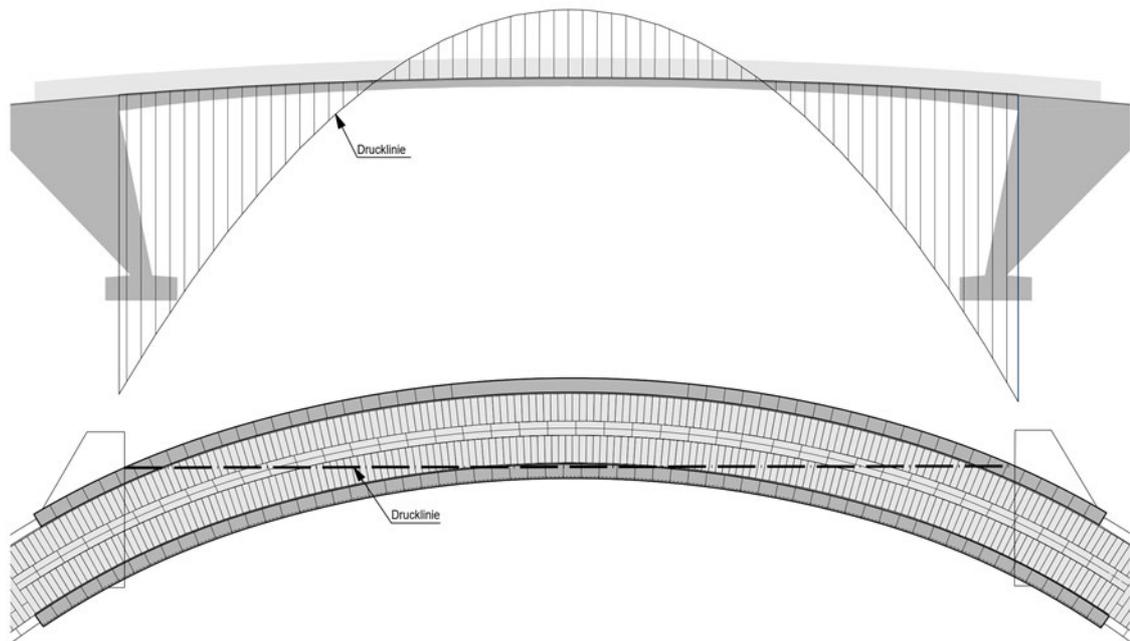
Ponte Punt: linea di pressione in pianta e in prospetto. La posizione arretrata della linea di pressione dalle fondazioni riguarda unicamente la traversa del telaio ed è dovuta all'influenza non mostrata del notevole peso delle spalle inclinate all'indietro
